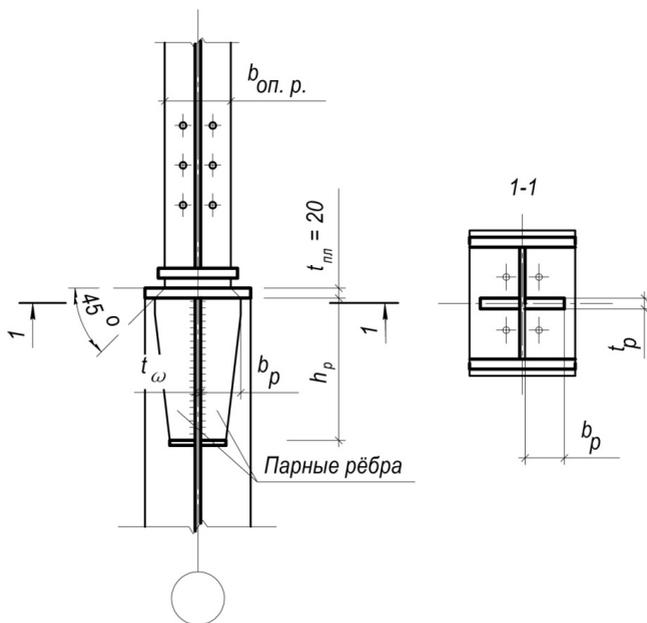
Фрагмент узла сопряжения главной балки и колонны
